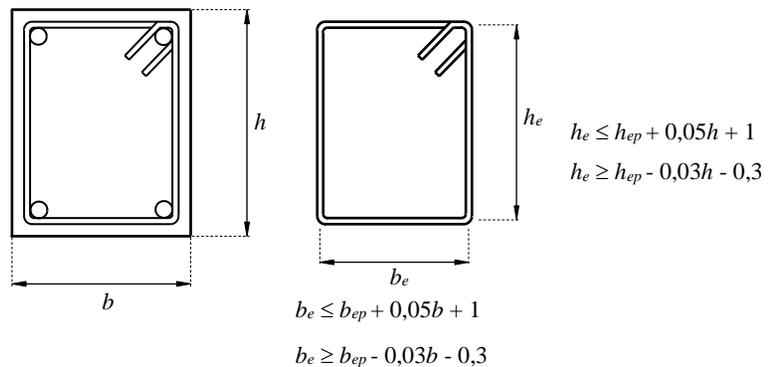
Tolerancias en extremos de traves o vigas en la dirección del refuerzo principal
